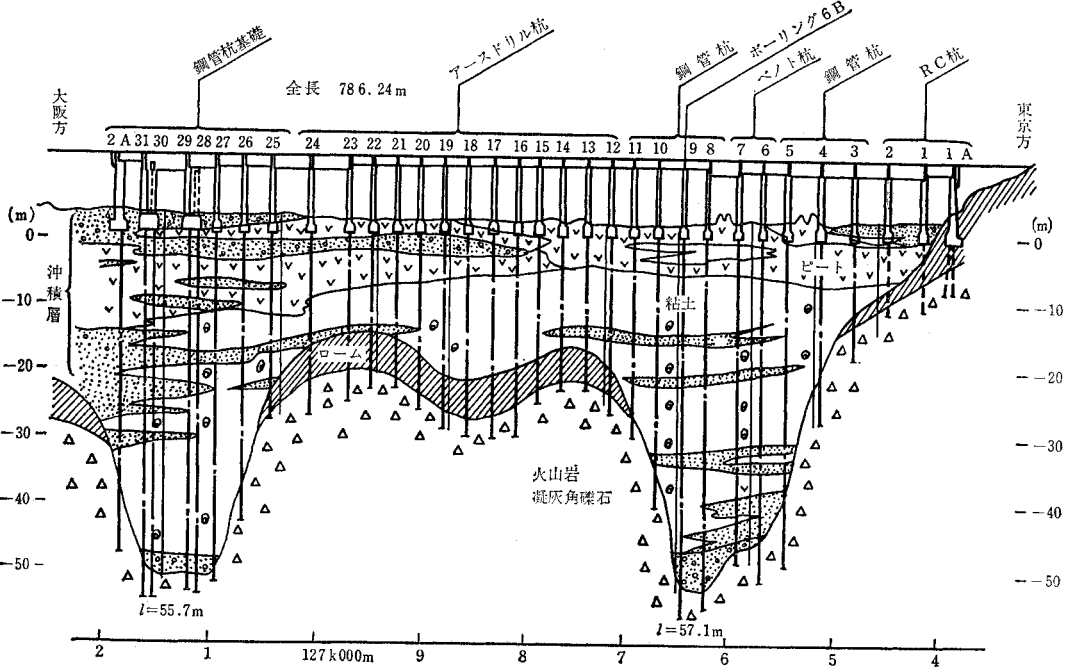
吉原付近江尾橋梁基礎地盤土質縦断面図
